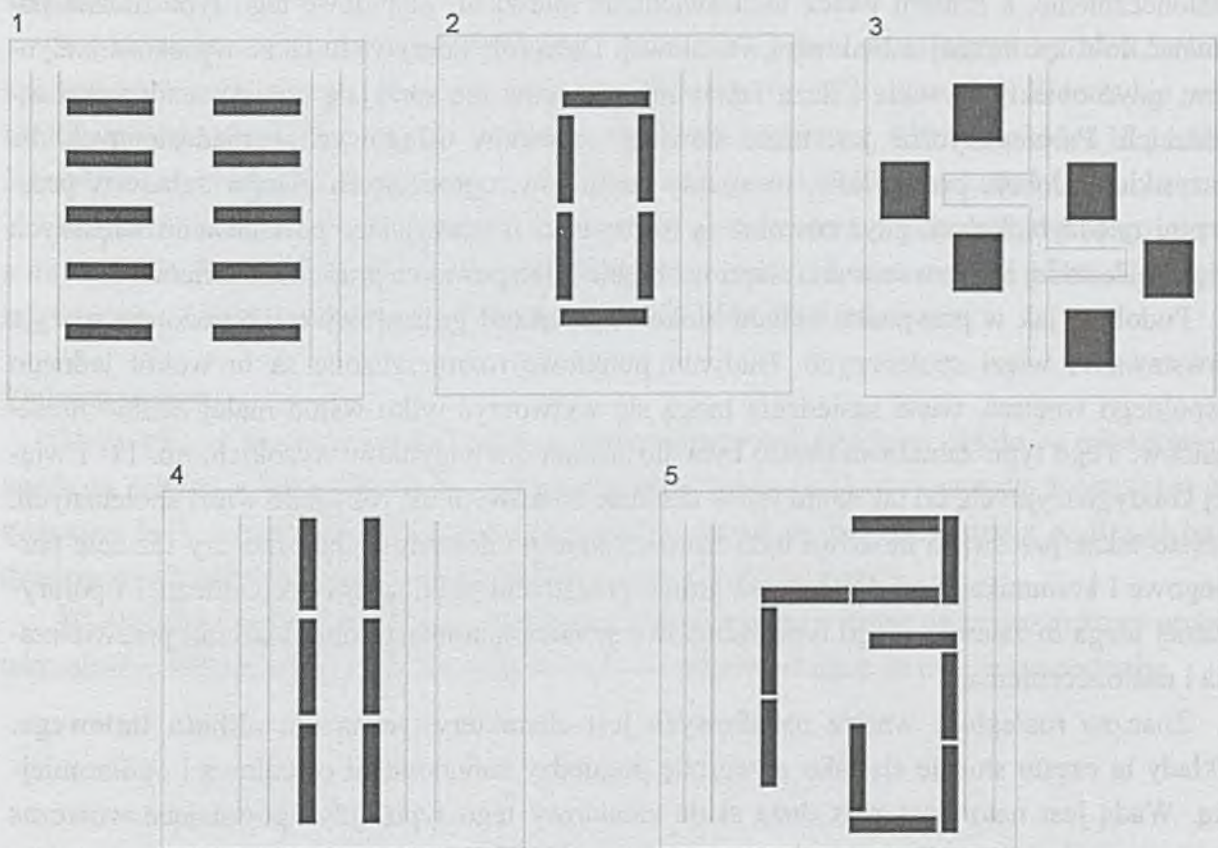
Warszawa, Os. Sady Żoliborskie, plany, widoki
